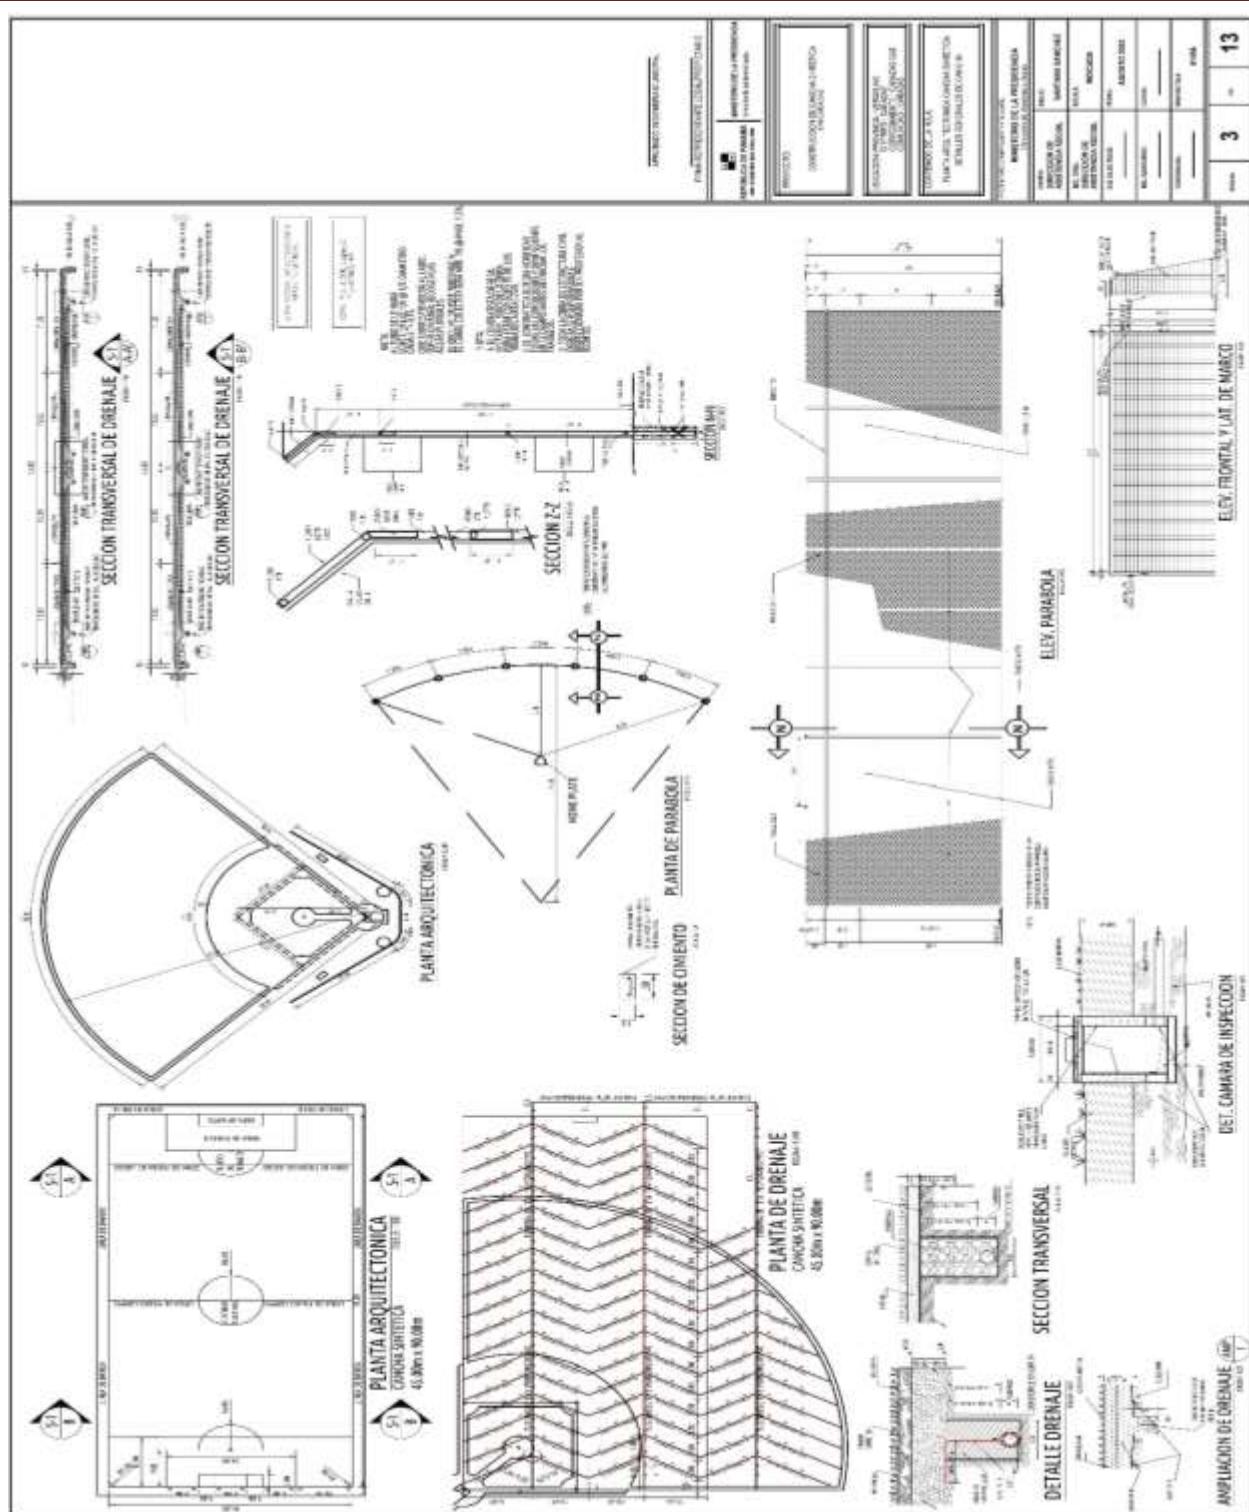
Planta arquitectónica: cancha sintética (sección transversal de drenaje, sección Z-Z y N-N, drenaje, detalle de drenaje, sección transversal, ampliación de drenaje, cámara de inspección, planta de parábola, elevación, elevación frontal y lateral de marco).
